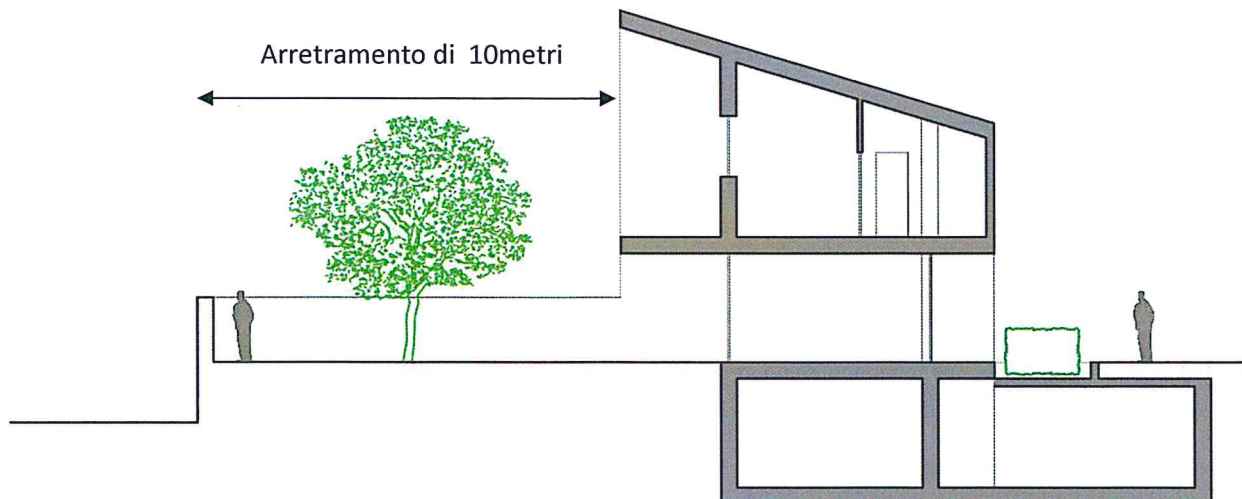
Sezione della tipologia tipo della casa a schiera prevista nell'area residenziale "Il Belvedere" con il mantenimento del muro in sasso che avrà una altezza interna pari ad un metro.
